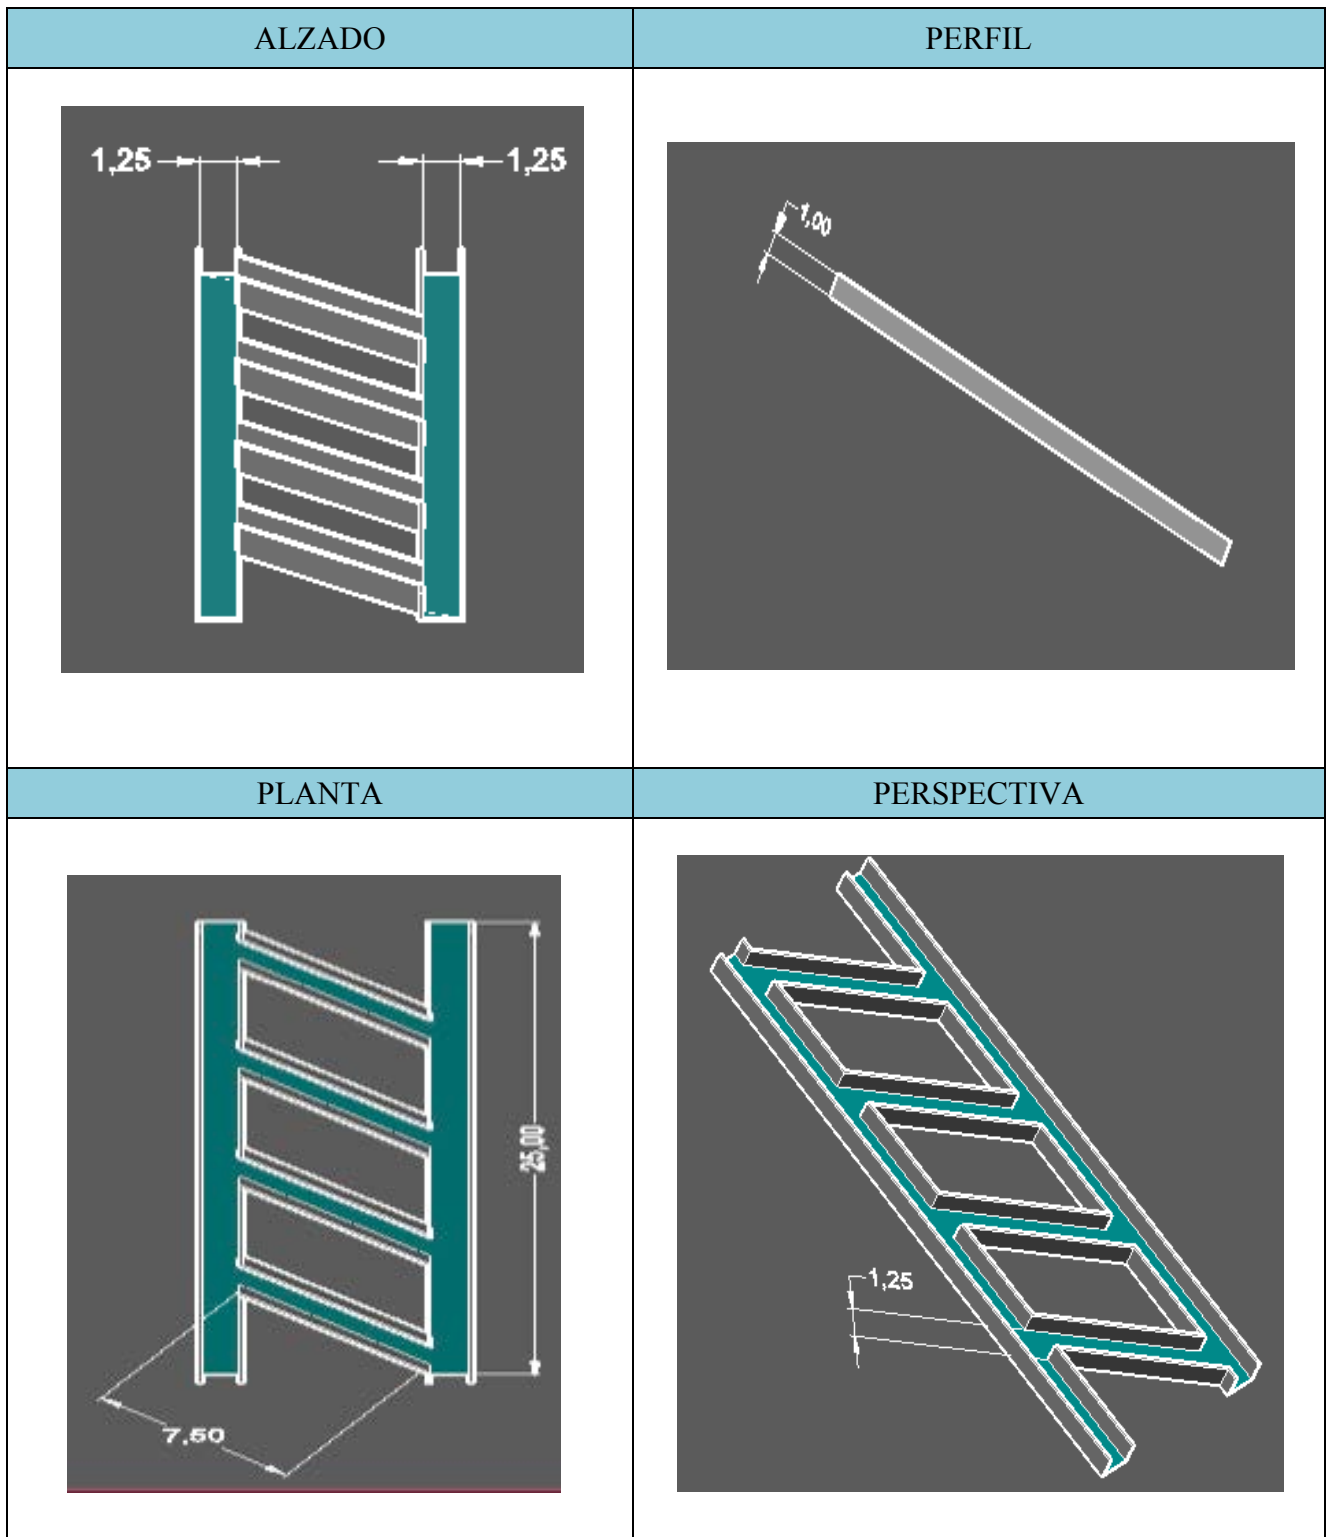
Ficha técnica (alzado, perfil, planta y vista en perspectiva *SO*) del drenaje con canales laterales (alternativa C).
